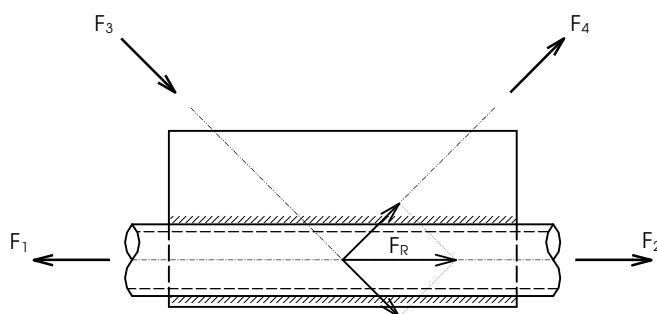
Fixação da chapa de ligação atravessando o banzo da treliça.
